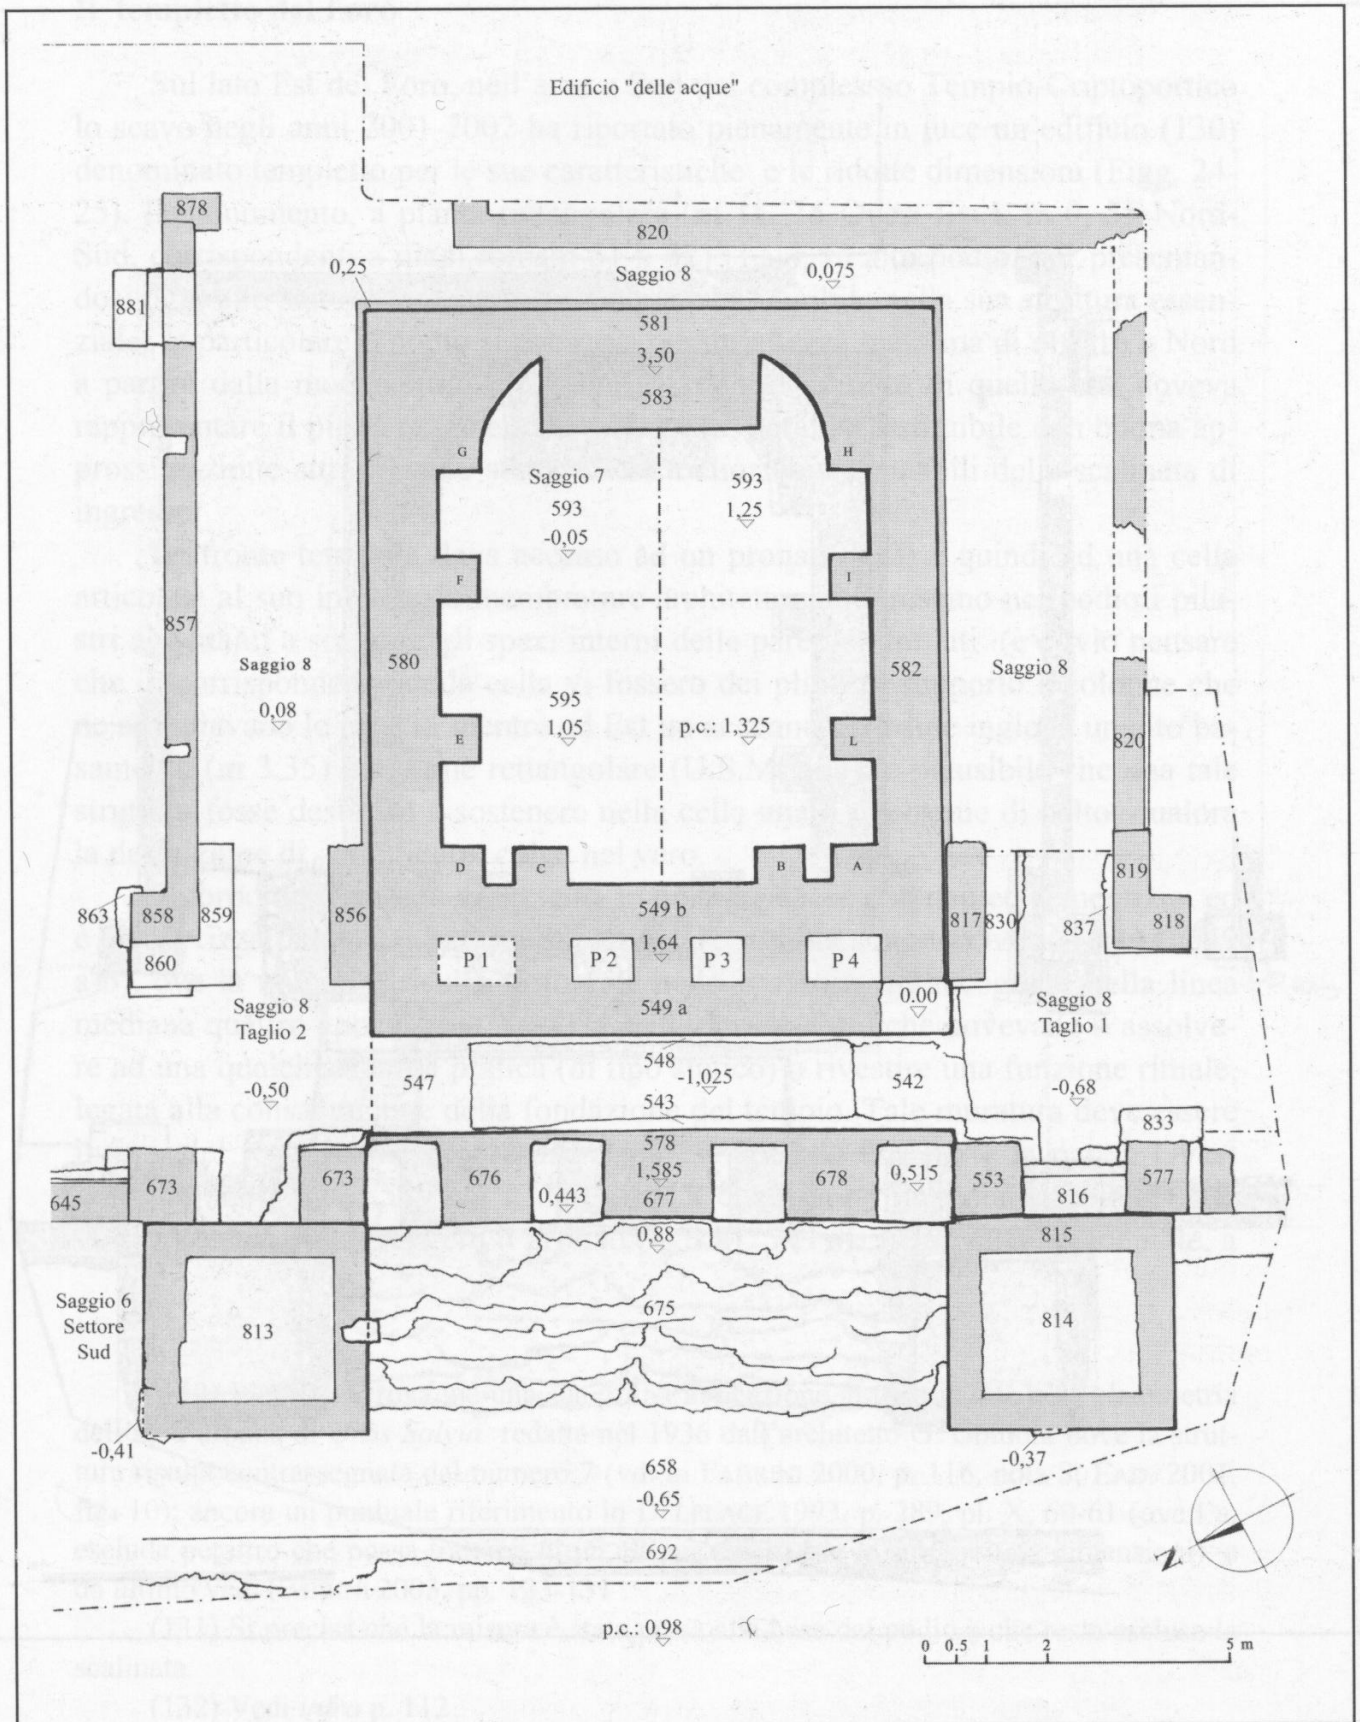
Pianta schematica del tempietto del Foro. Rilievo e disegno G. Montali.
